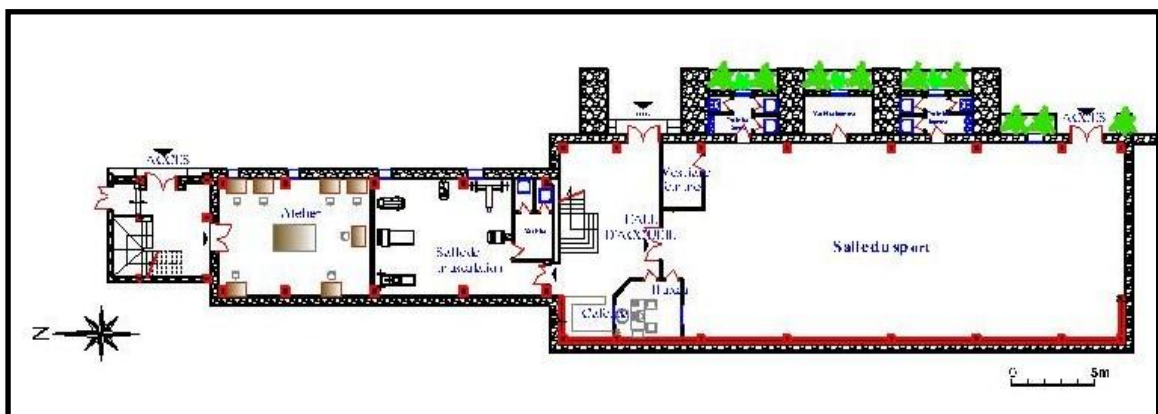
72 : Proposition du plan rez-de-chaussée lors de la réhabilitation. (Cuviers).
